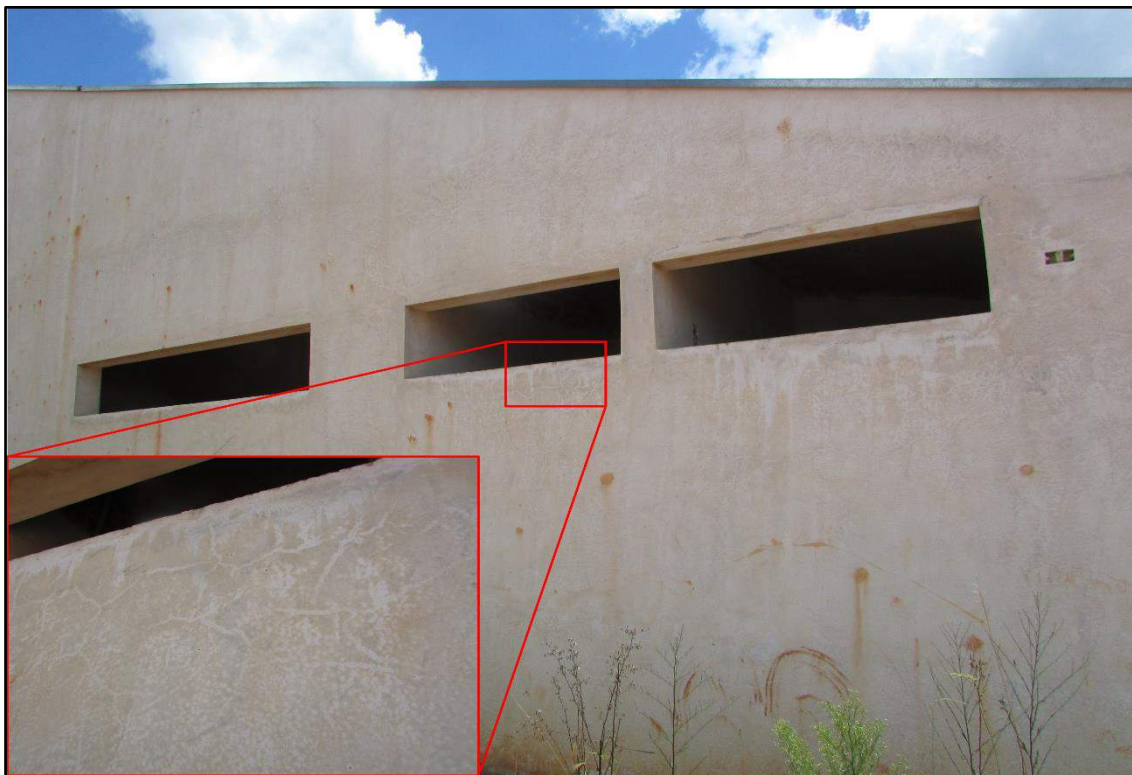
Detalhe de fissuras mapeadas no revestimento externo. (Parede externa da despensa). Revestimento se encontra com boa aderência.
